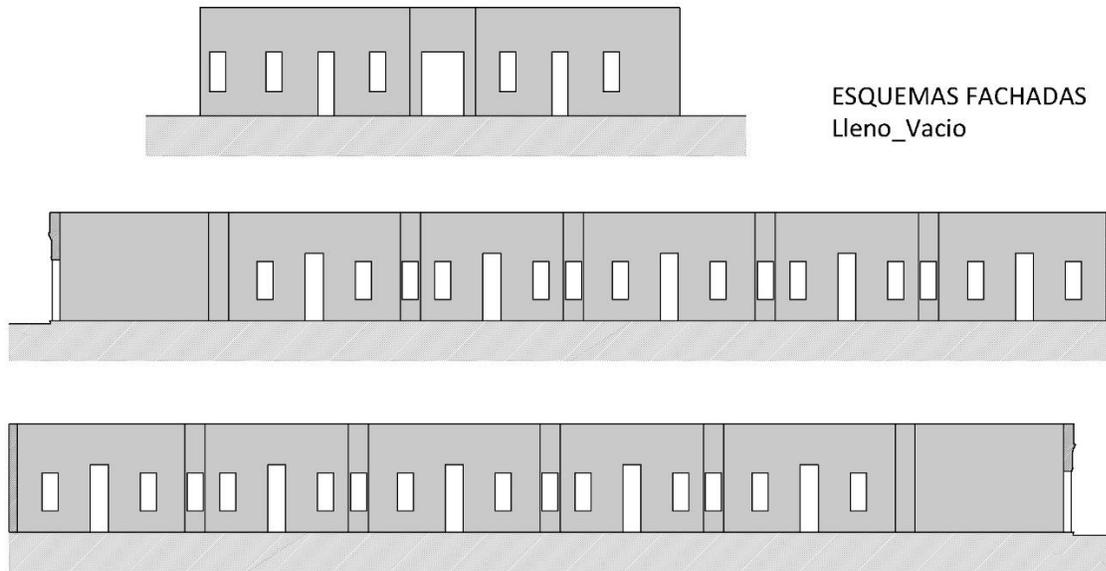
Esquema de fachadas consideradas para el cálculo de porcentajes.
